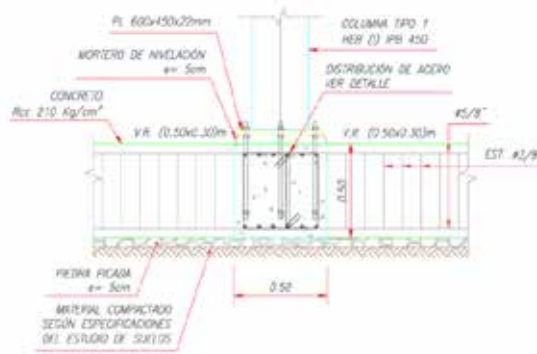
Detalle de Viga de Riostra con Columna. (2016).
